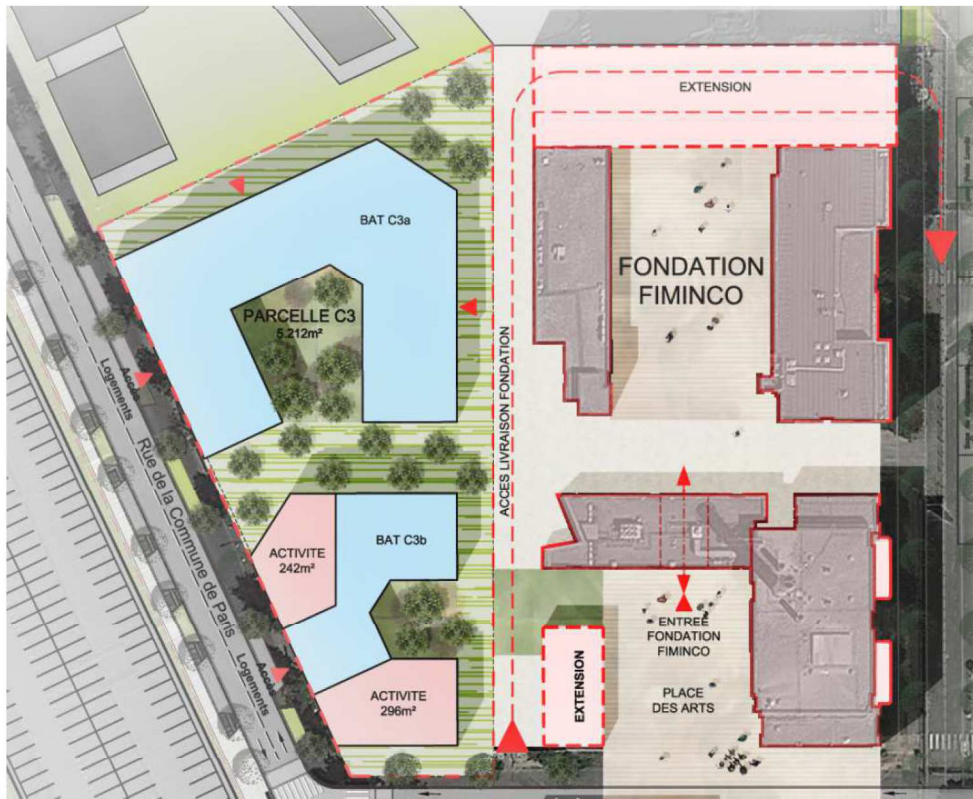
Plan masse du programme (hors emprise FONDATION FIMINCO)
